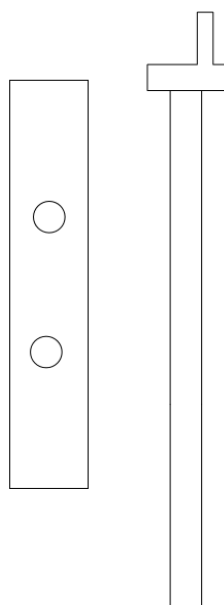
Vista de topo e lateral da fundação em estaca escavada em E2
